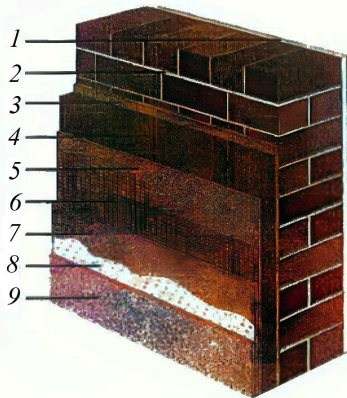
Опорядження фасаду штукатуркою Ceresit в системі утеплення мінеральною ватою:
